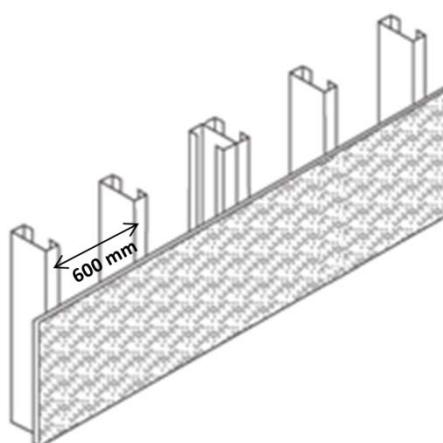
Detalhamento do espaçamento máximo entre perfis (sem escala)
